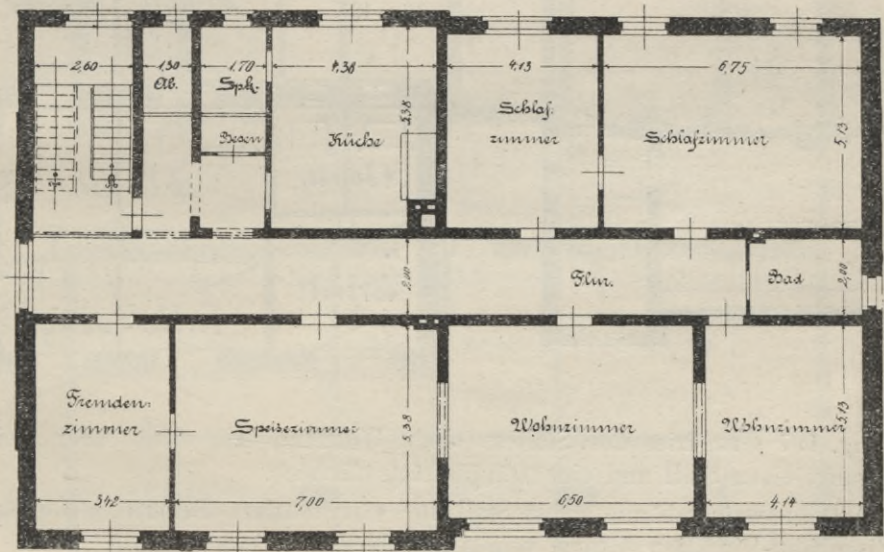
zeigt den Grundriss des Obergeschosses. Das ganze Geschoss ist in eine Dienstwohnung eingerichtet, welche aus dem Flur, einem Fremden-, einem Speisezimmer, zwei Wohn-, zwei Schlafzimmern, Küche, Speisekammer, Badezimmer und Abort besteht.
